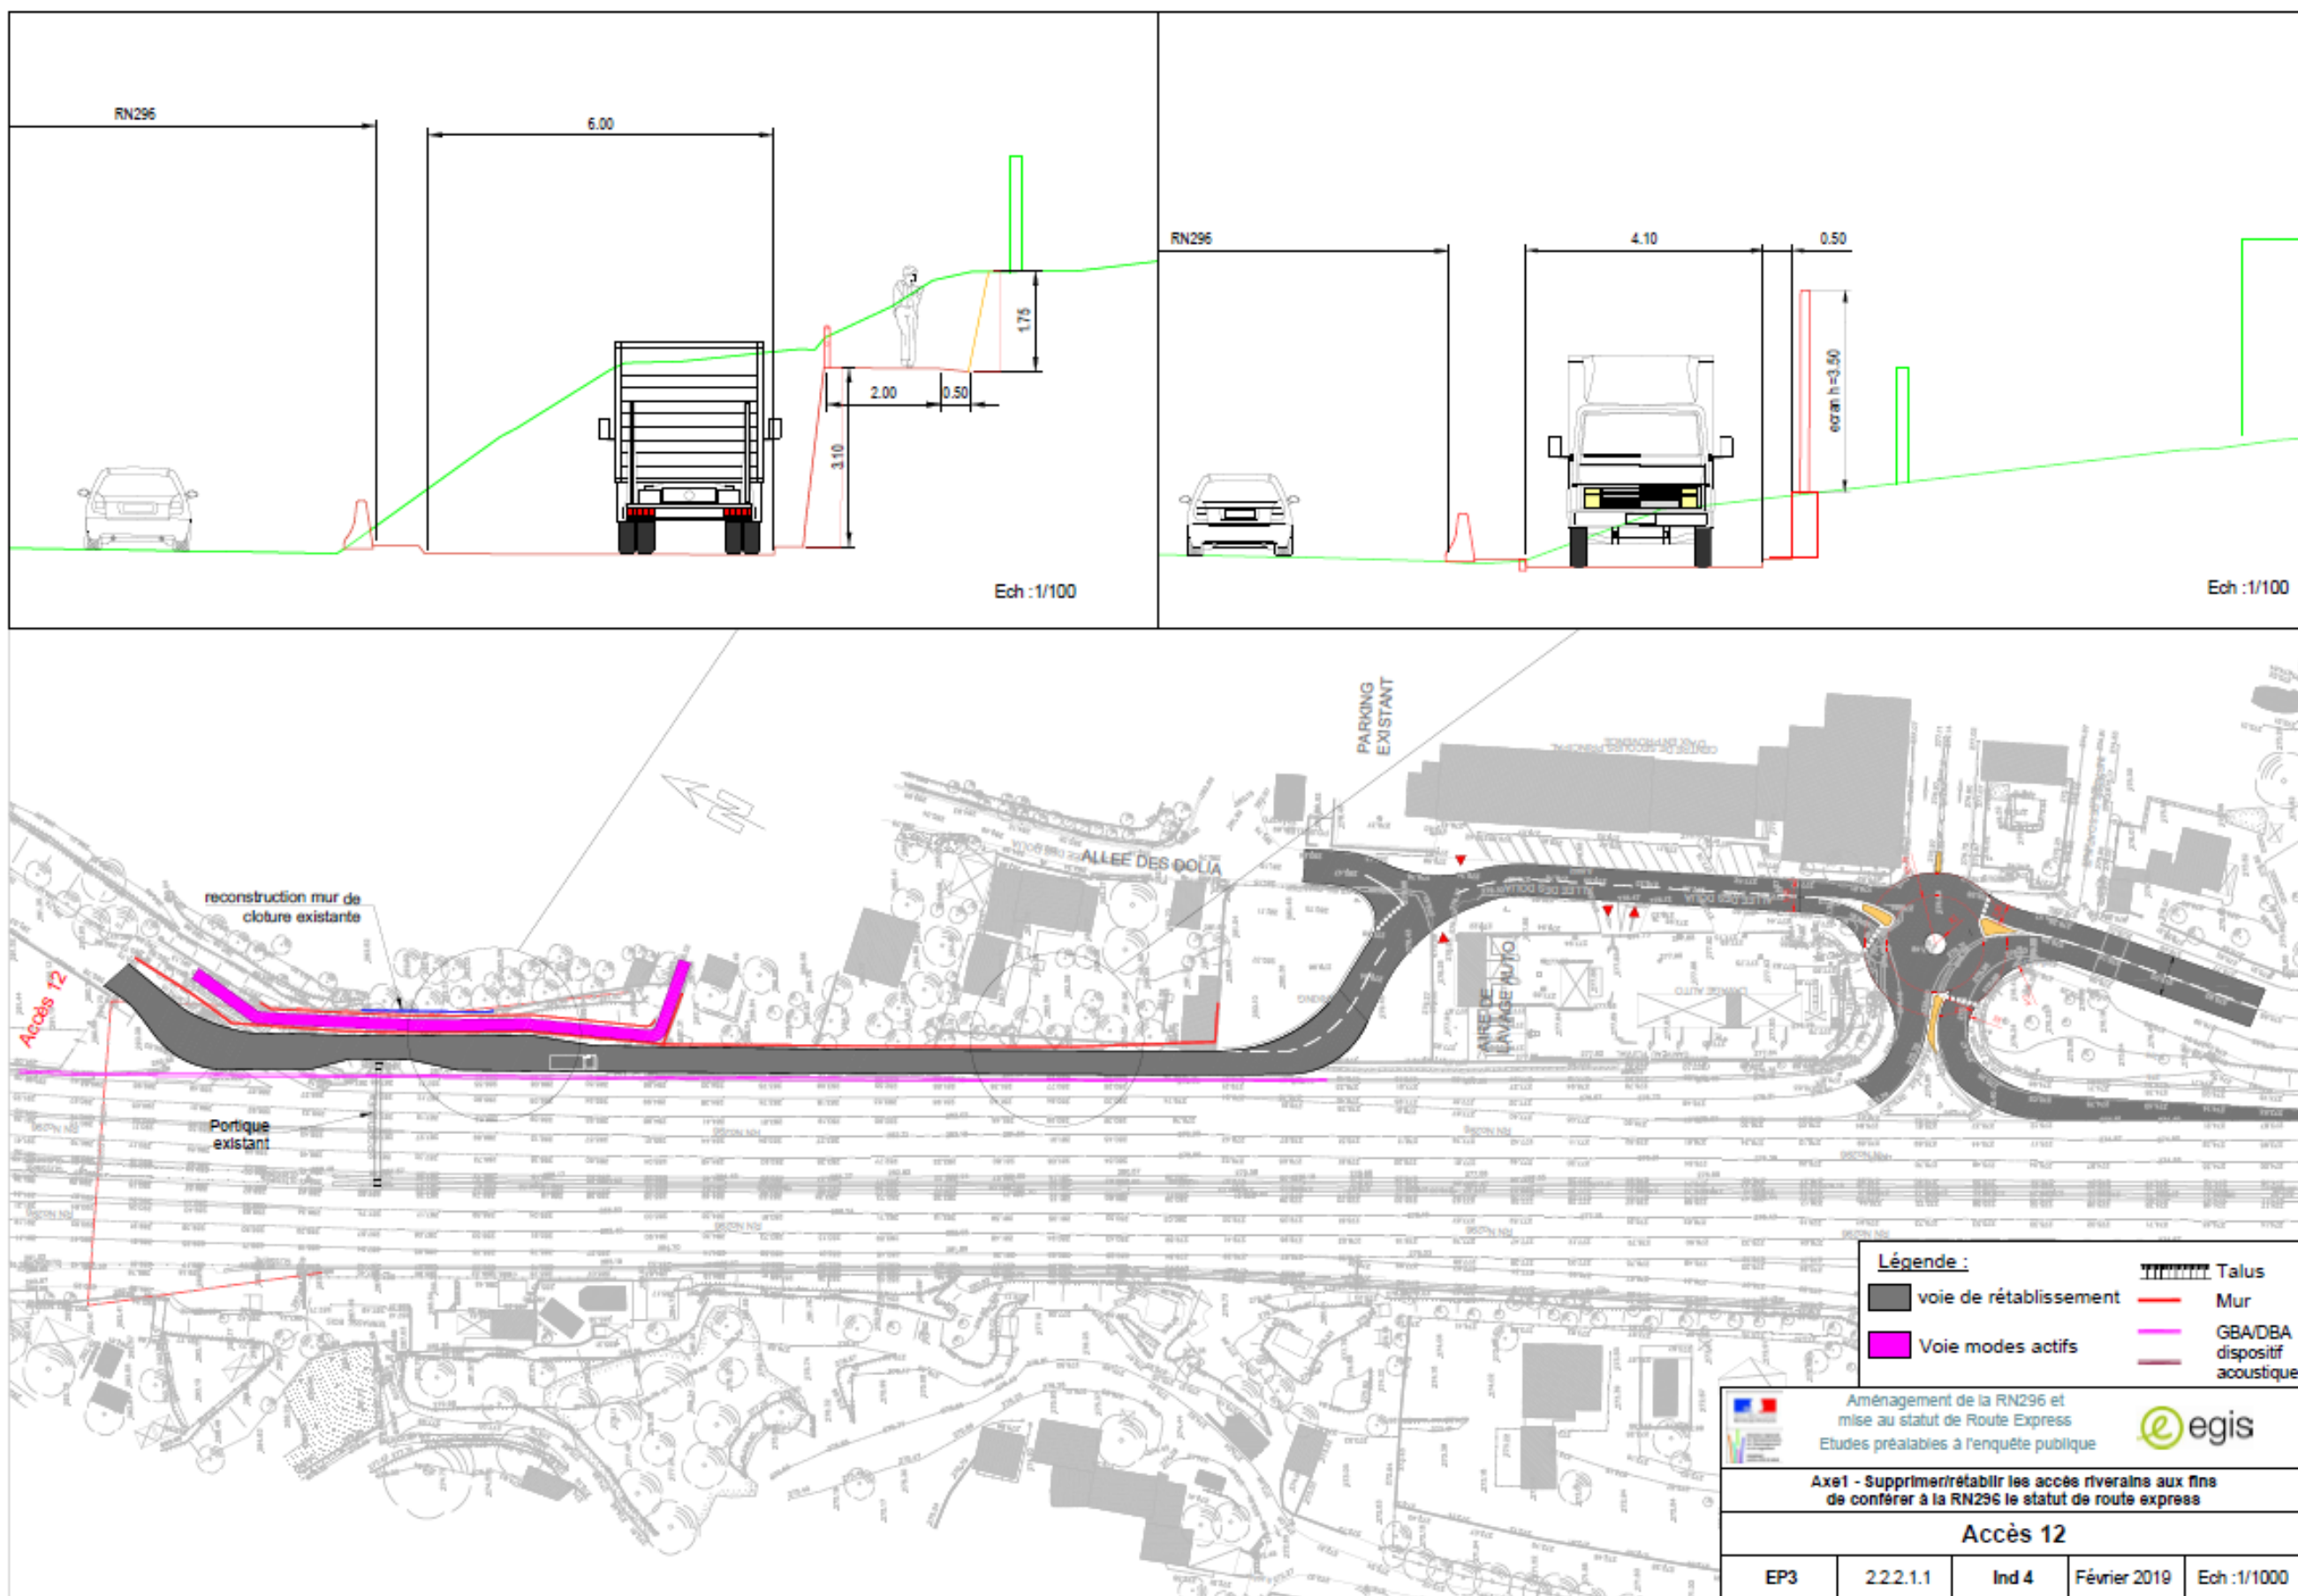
Profil en travers et vue en plan du réaménagement de l'accès 12
